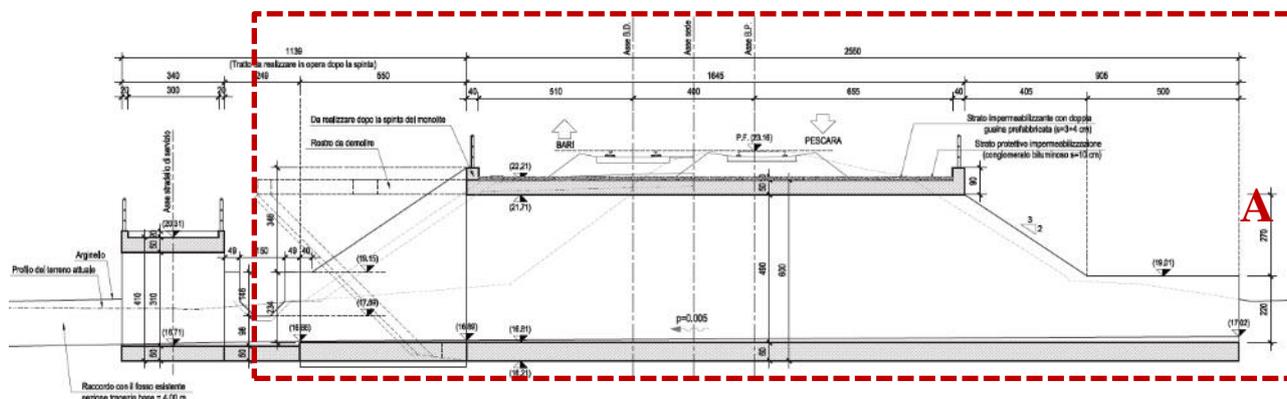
Adeguamento idraulico Fosso Capoposta - Sezione Longitudinale manufatto a spinta
